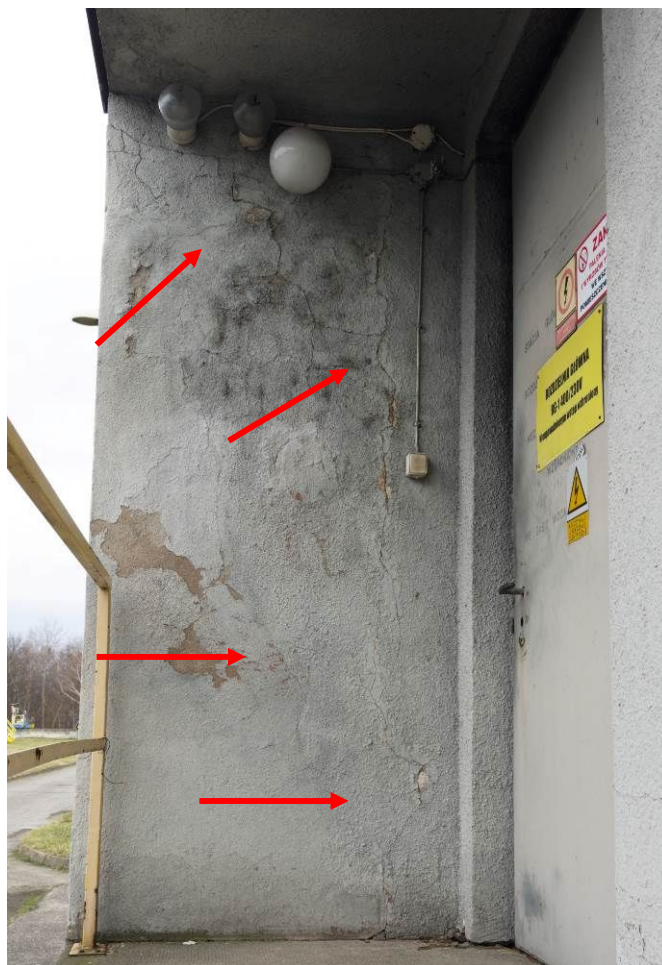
Zewnętrzna klatka schodowa - widoczny przechył w kierunku zachodnim, [4].
